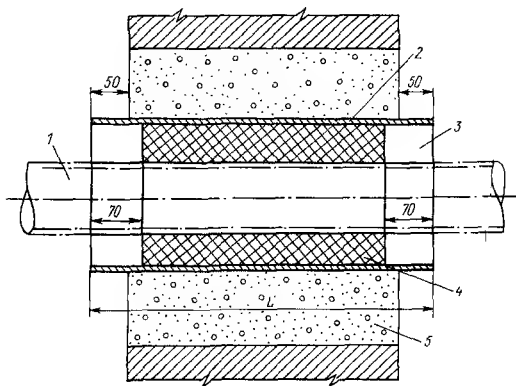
Футляр для прохода газопроводов через фундаменты и стены.
